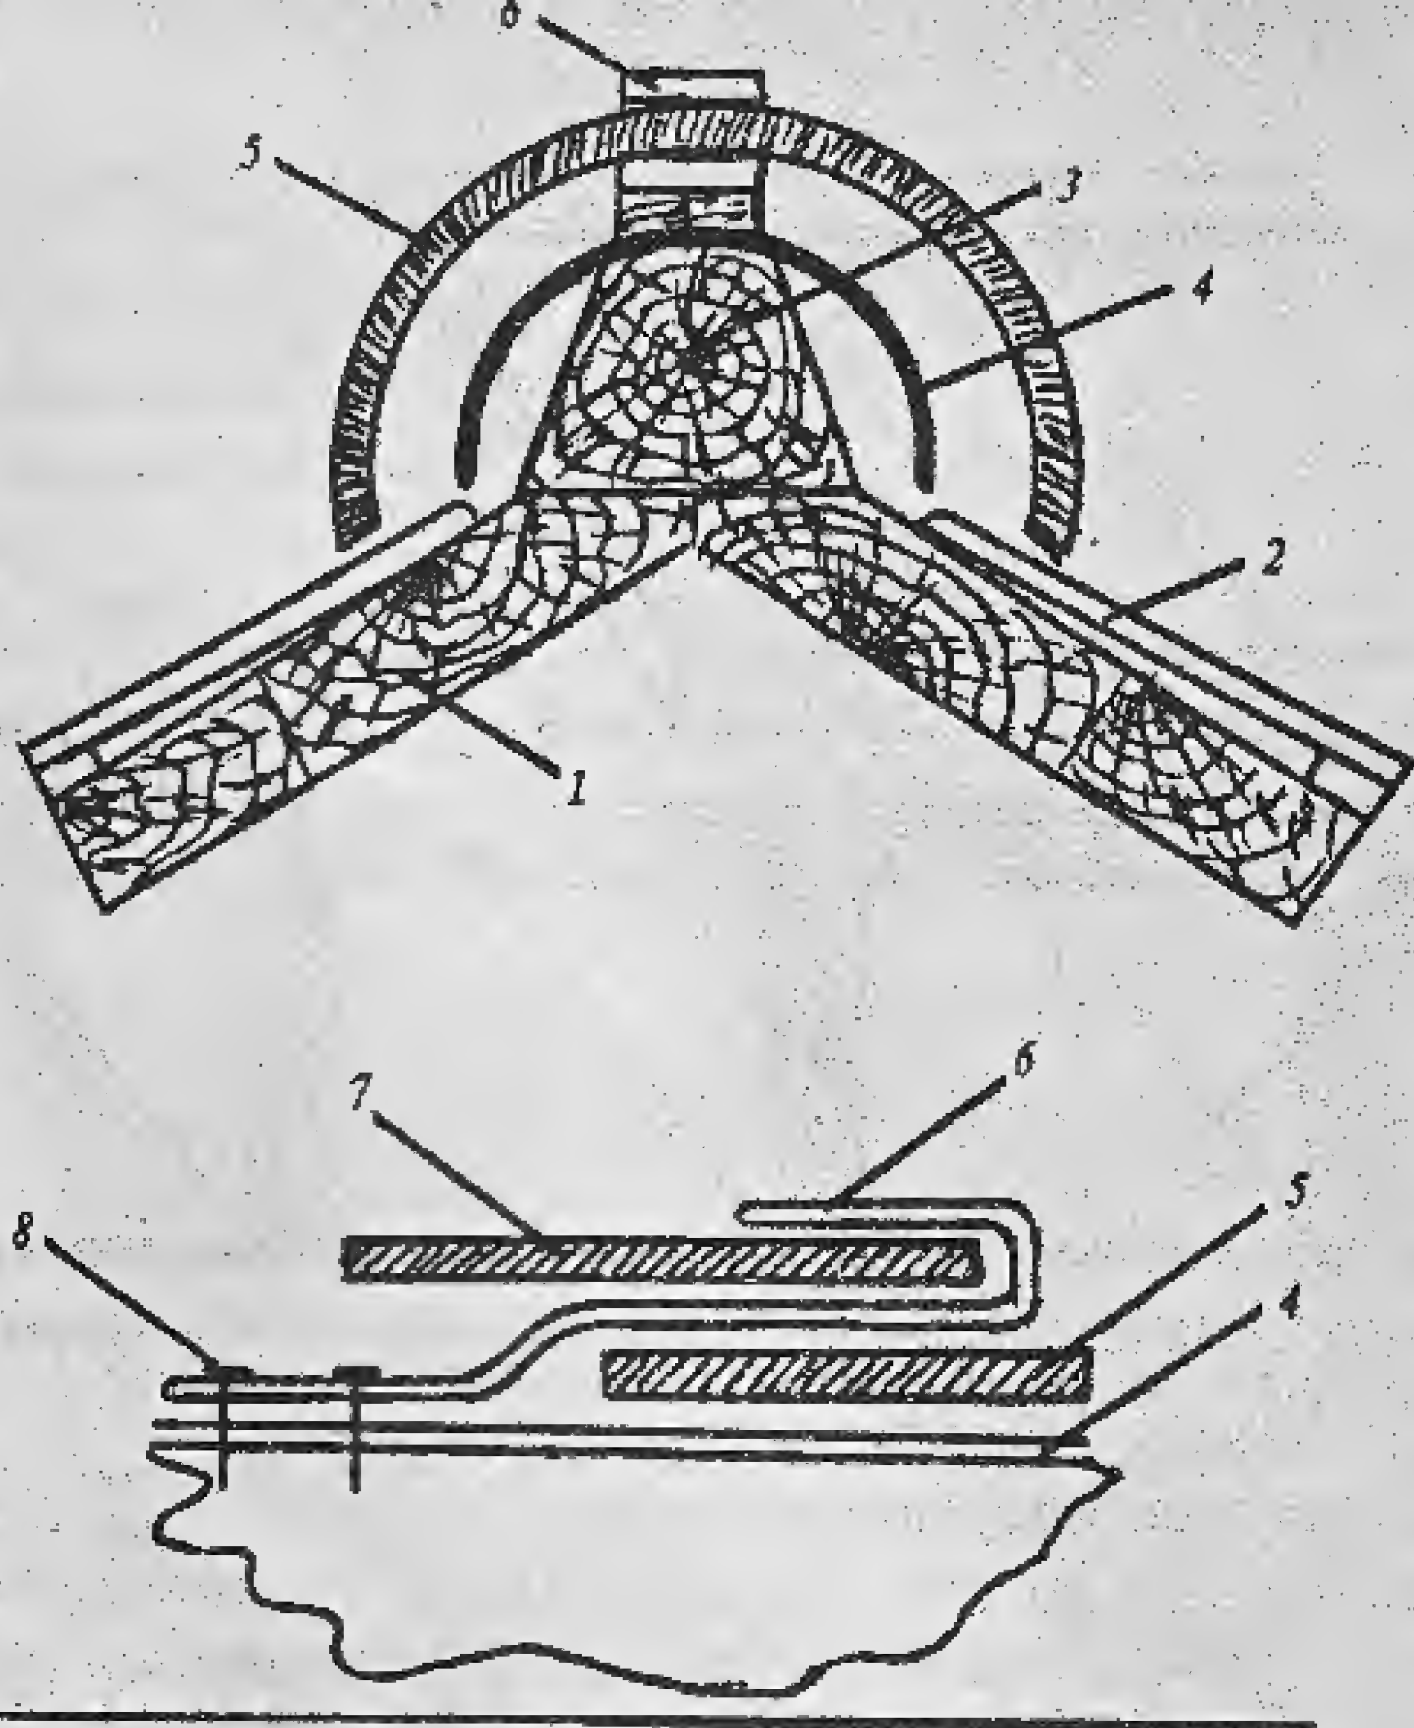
Покриття конька: 1 — кроквяна нога; 2 — шифер; 3 — коньковий брус; 4 — руберойдова стрічка; 5 — жолобчастий коньок; 6 — скоба; 7 — накриваючий кінець жолобчастого конька; 8 — цвях.
